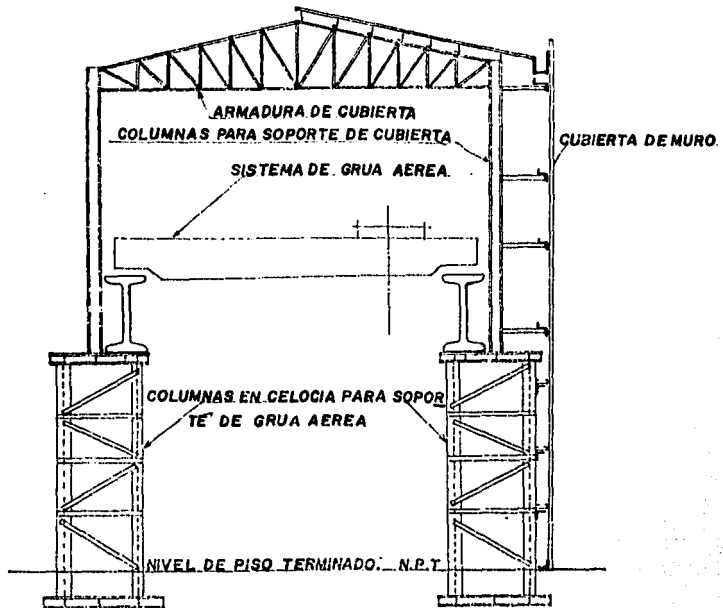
Sección transversal típica de nave industrial estructurada en acero.
